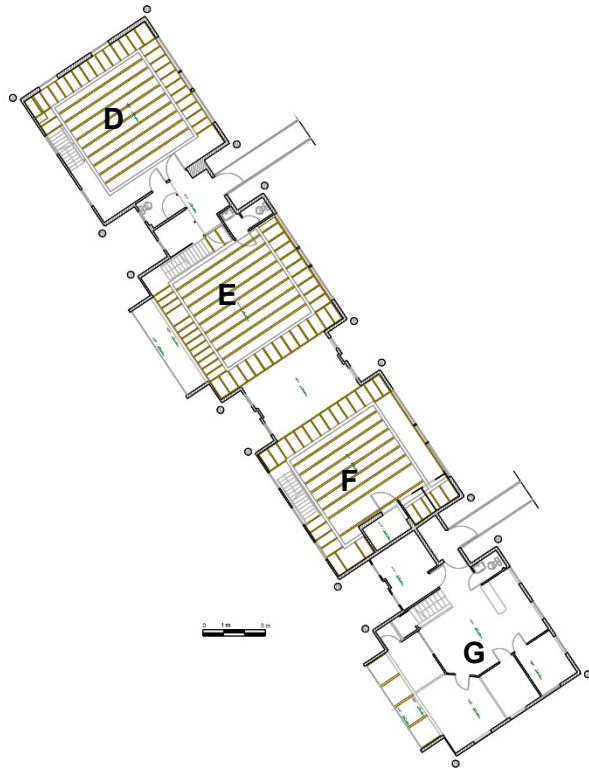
niveau rez-de-chaussée surélevé – état existant
